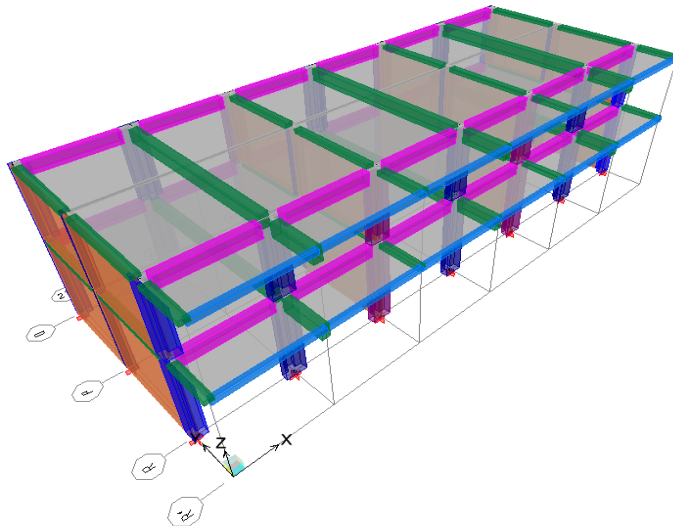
Modelado Pabellón 1 - Aulas 3D vista frontal
